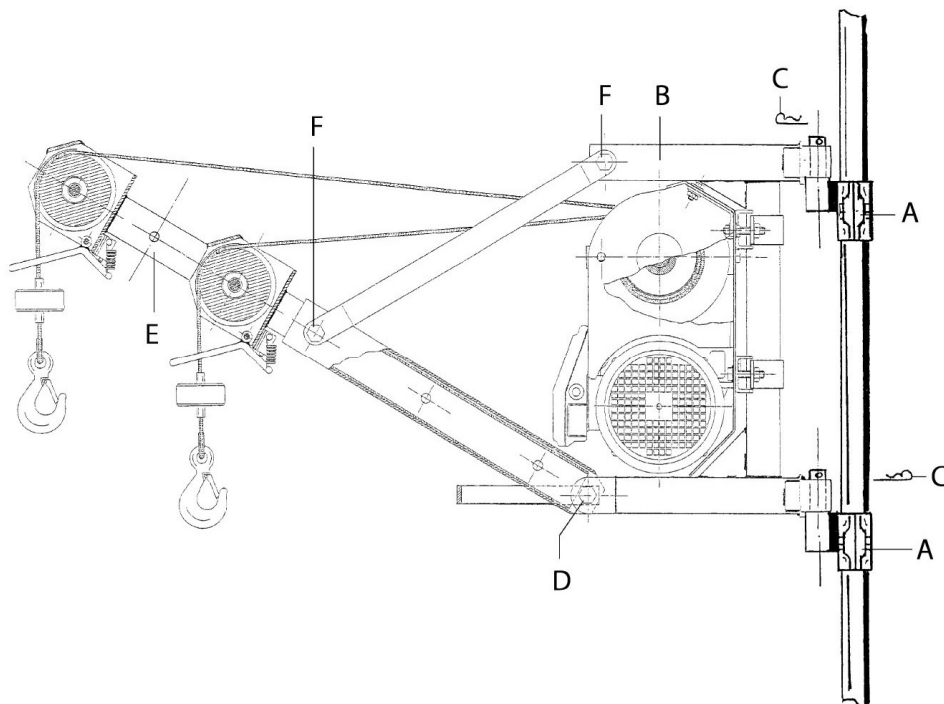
Installation de l'élévateur sur étau ou structure porteuse
